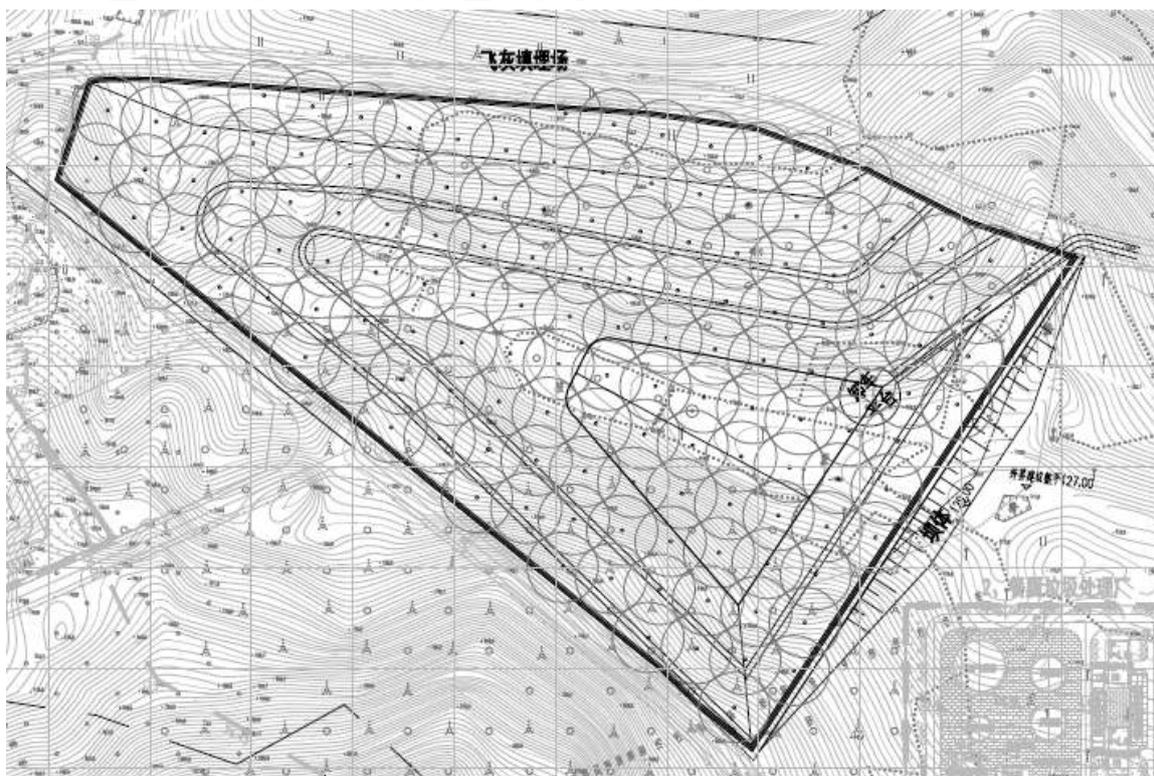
飞灰填埋区导气石笼平面布置图
